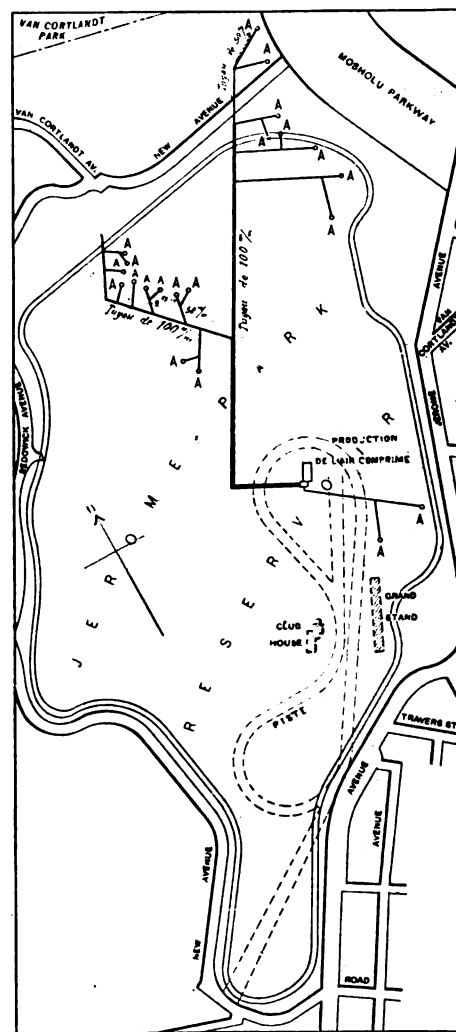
Plan du réservoir et de la canalisation d'air comprimé.
